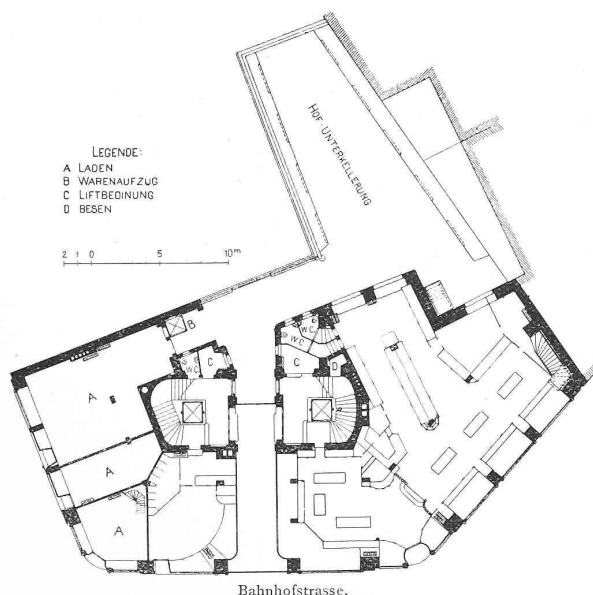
Grundriss vom Erdgeschoss. — Masstab 1:500.
